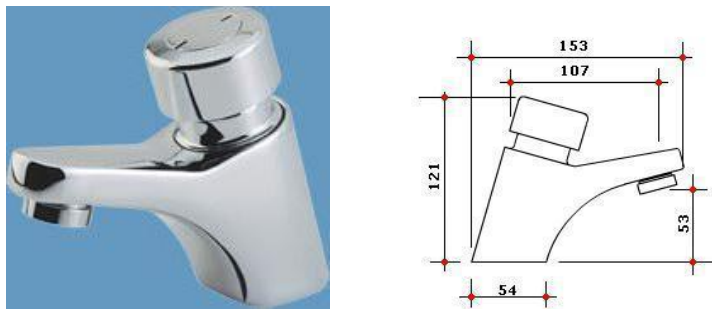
Torneira com fechamento automático (Dimensões em milímetros)
